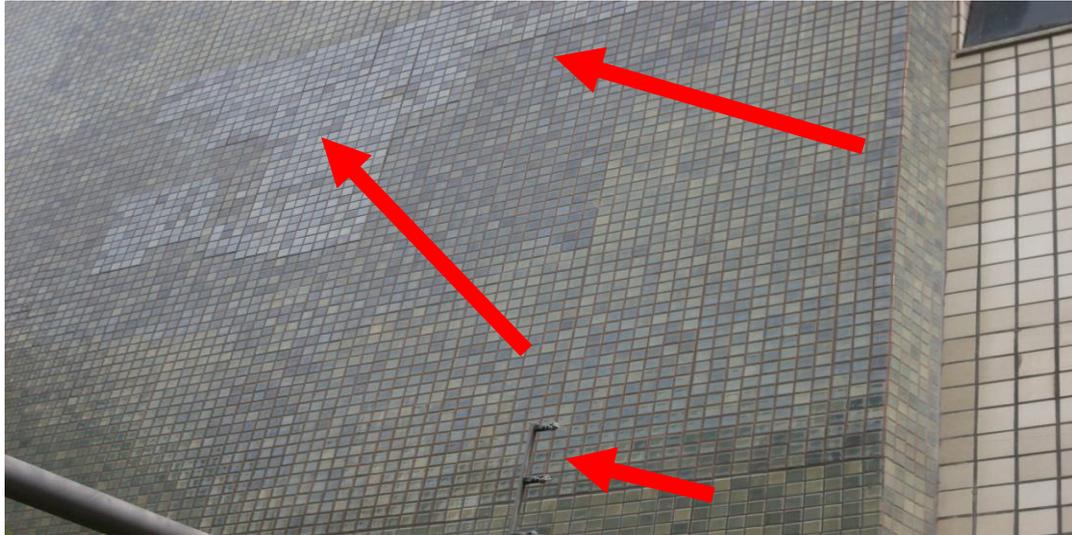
Revestimento em pastilha 5x5, marca Jatobá- assentado com argamassa colante descolamento do revestimento aproximadamente 6 meses após a entrega da obra
